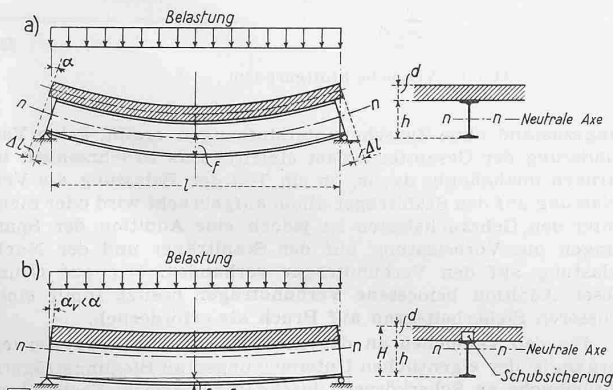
a) Stahlträger ohne Verbindung mit der Betonplatte
